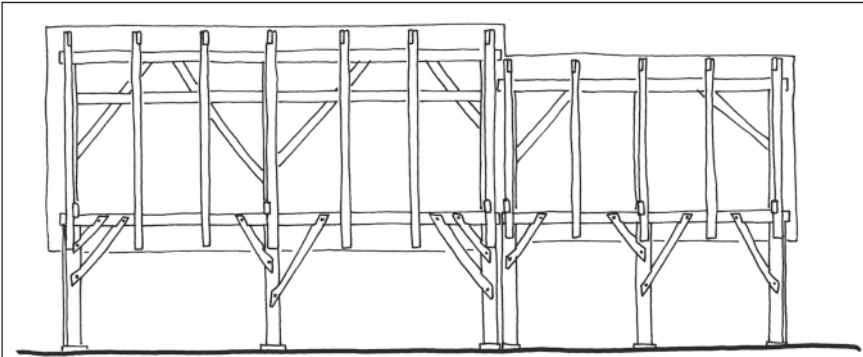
Wirtschaftsgebäude, Plandarstellung der Vordertraufe (mit Darstellung des Dachwerkes). Zweiteiliger Baukörper mit eingeschossiger Fachwerkkonstruktion in Formen des 14. Jahrhunderts mit rein kopfzoniger Aussteifung sowie einfachem Pfettendach (Zeichnung: Verf.; Maßstab ca. 1:140).
